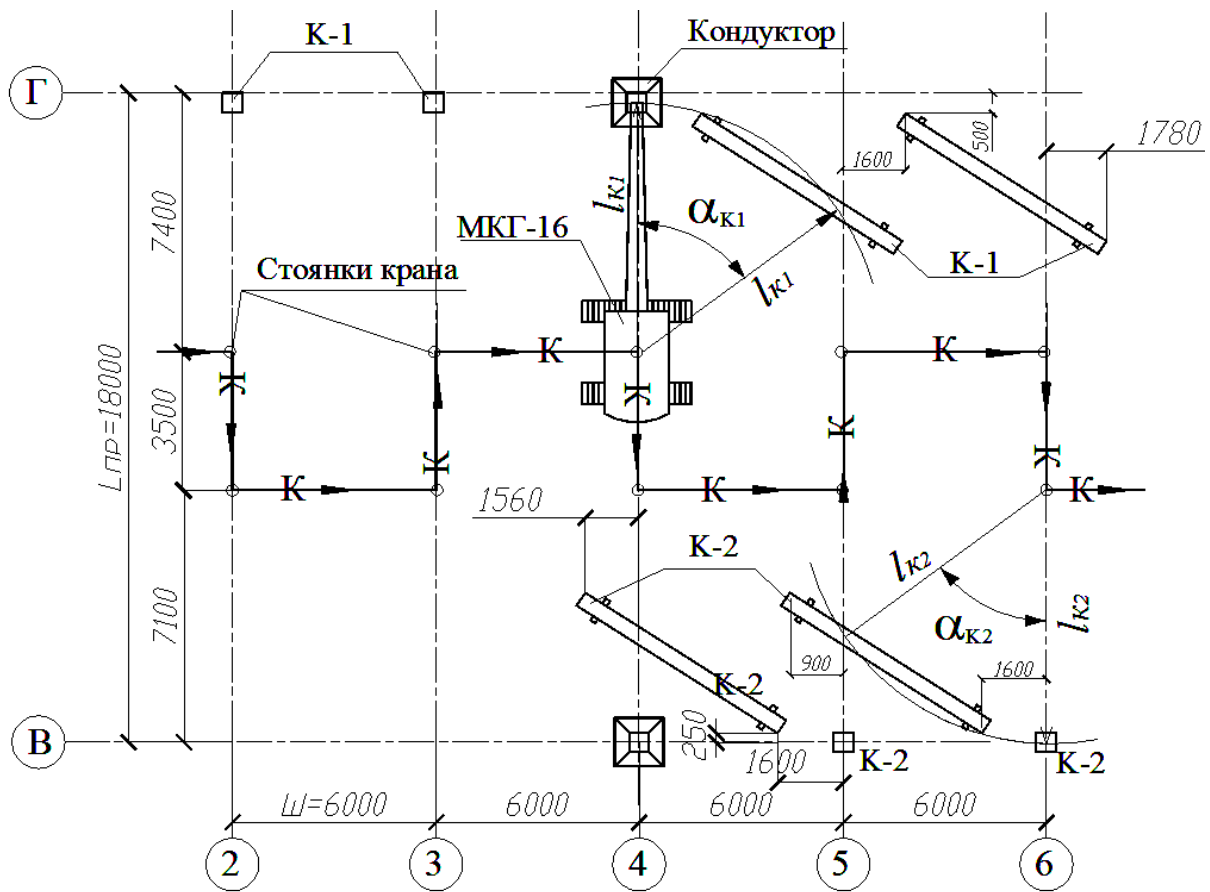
Схема монтажа колонн способом поворота с перемещением крана по зигзагу
